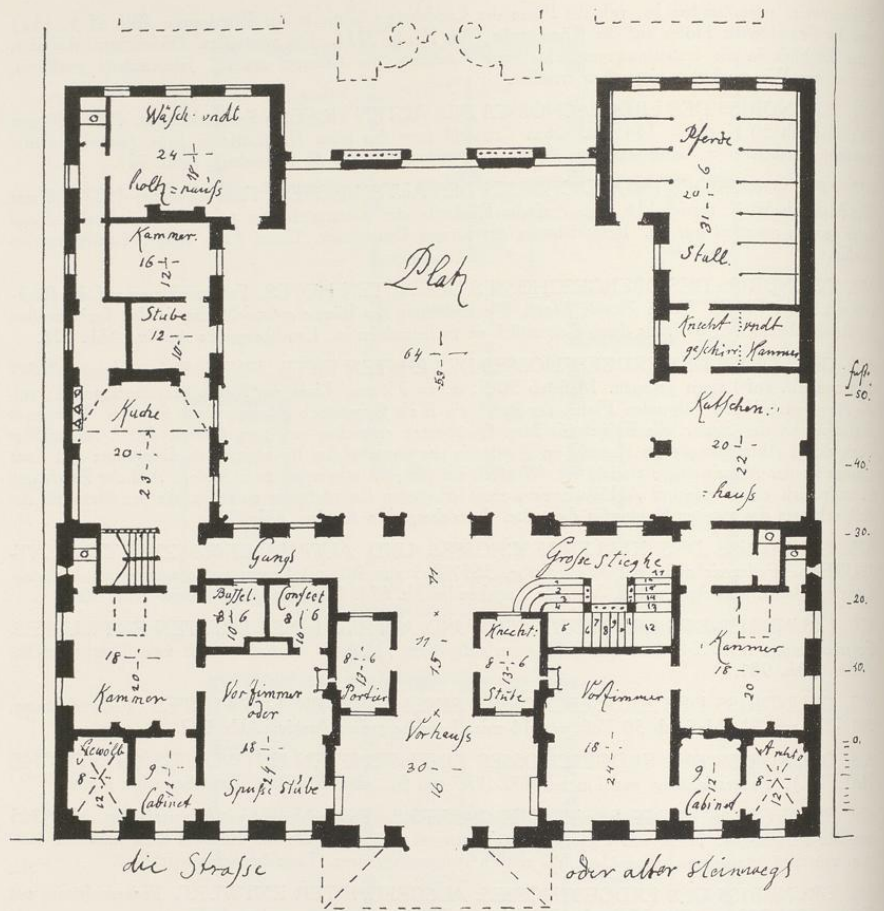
Grundriß des Erdgeschosses des ersten Entwurfes. Pause der Bauzeichnung Nr. 664
